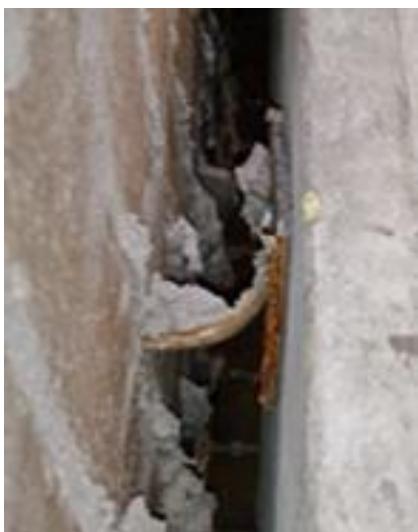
Ненадежное крепление лицевого каменного слоя к внутренней железобетонной стене с помощью гибких связей
